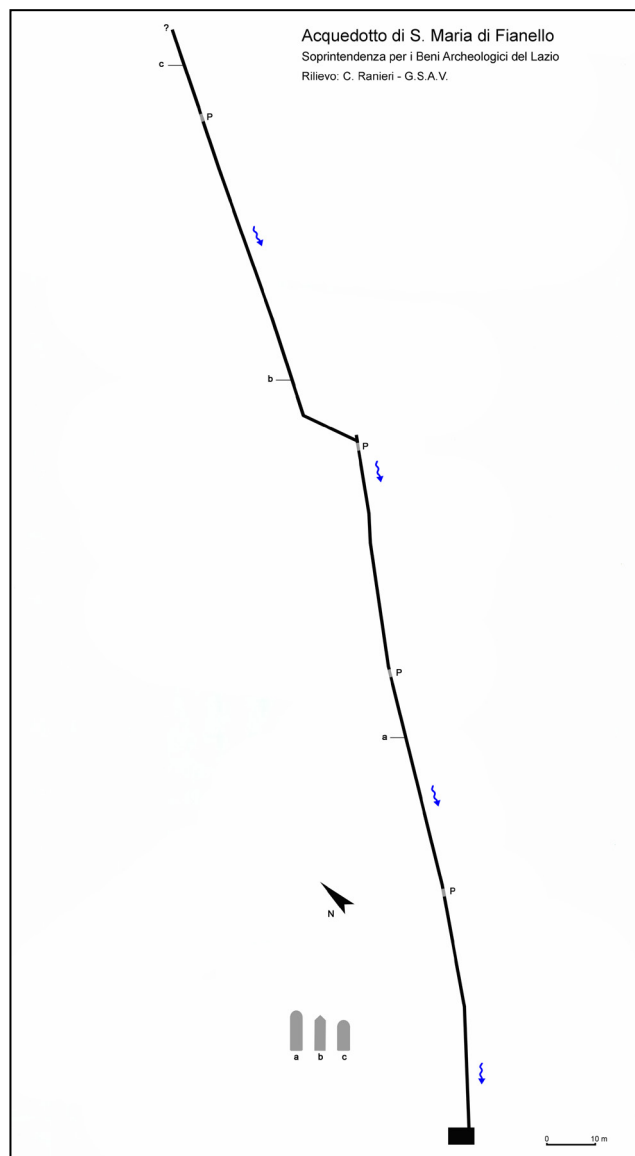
Pianta e sezioni dell'acquedotto di S. Maria di Fianello (rilievo C. Ranieri).
